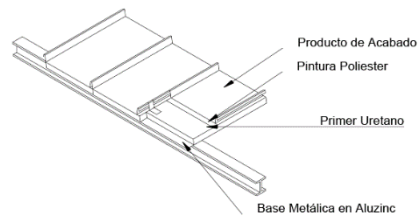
Detalle Cubierta Tipo Sandwich
